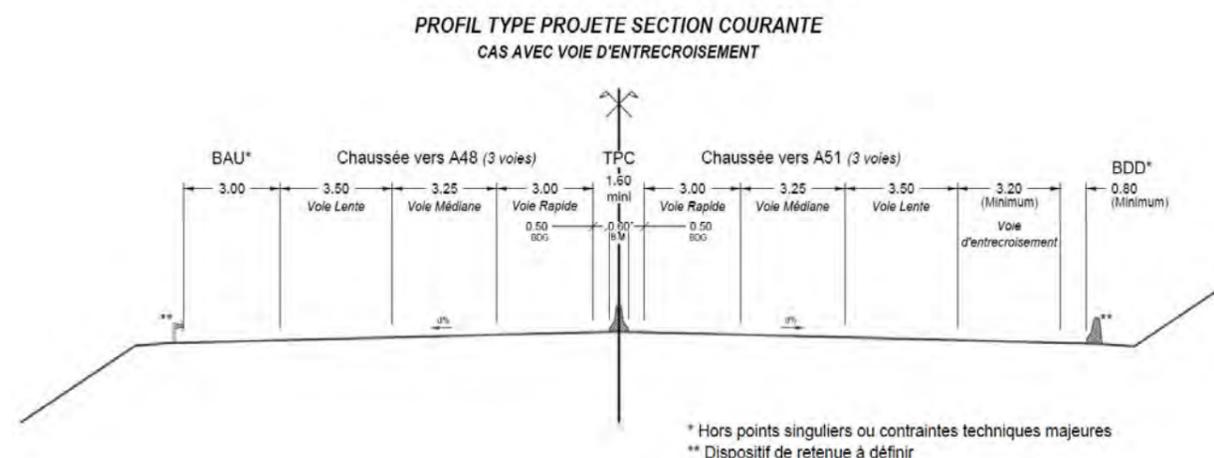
Profil en travers type projeté – Cas avec voie d'entrecroisement
